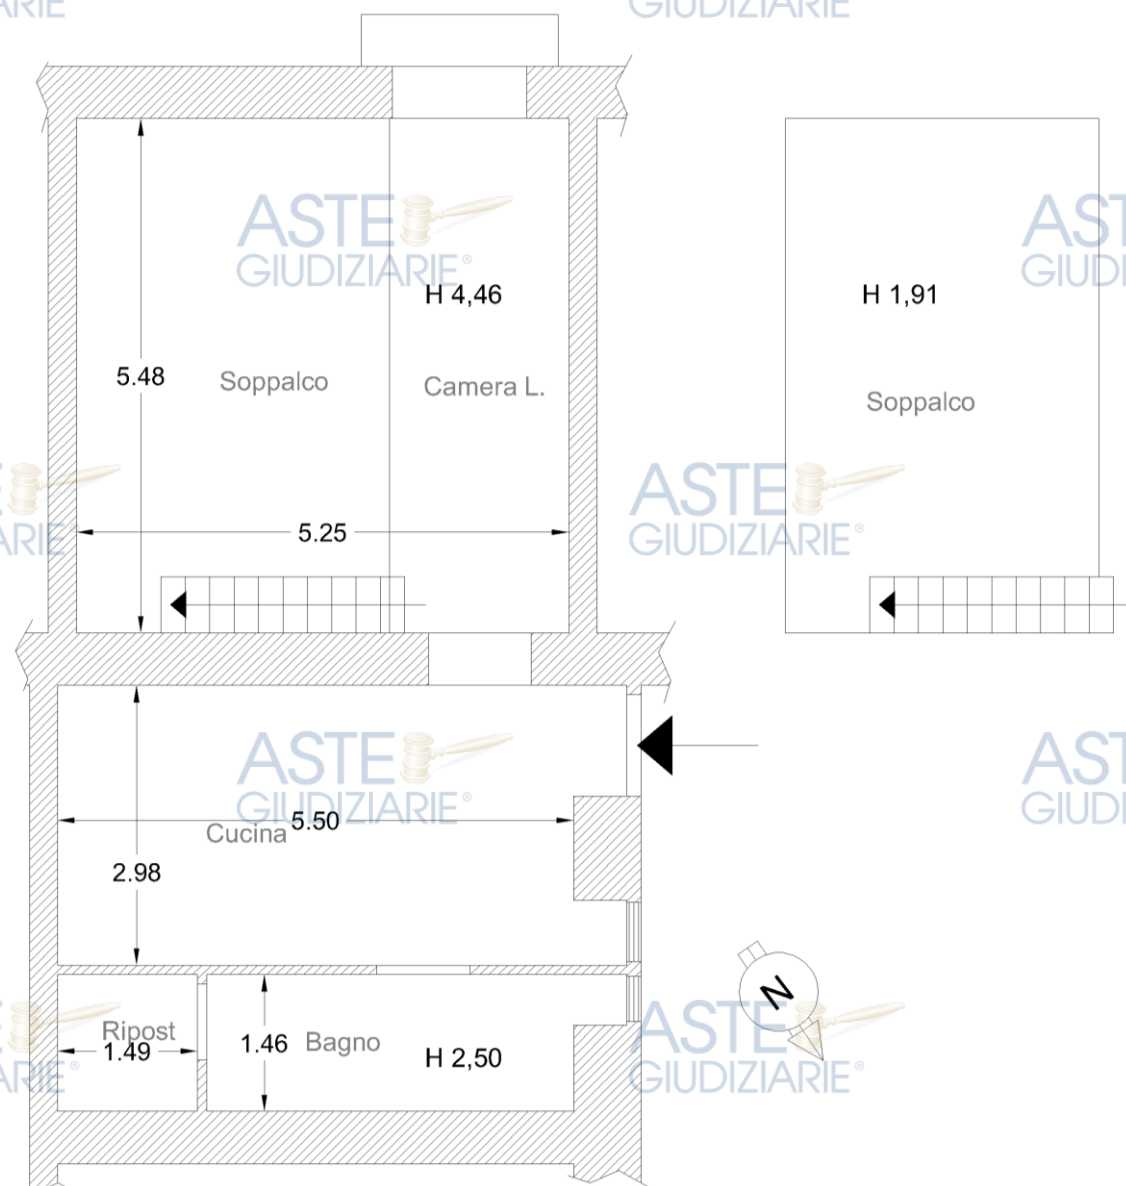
Planimetria nello stato di fatto - Piano secondo.
